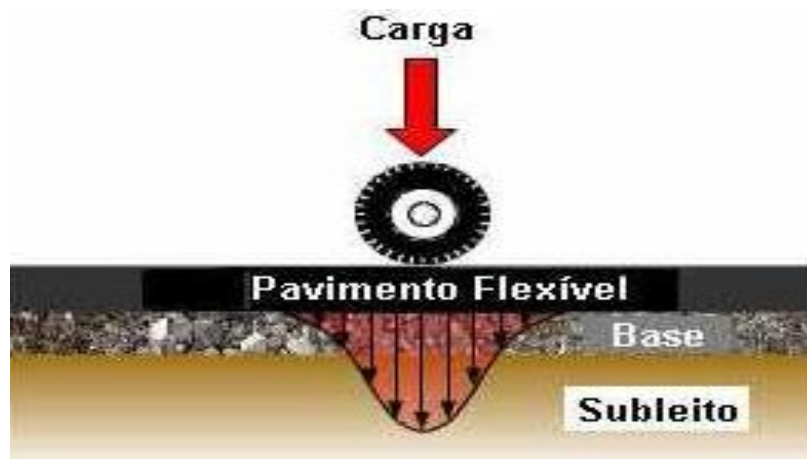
Distribuição da carga no Pavimento Asfáltico
